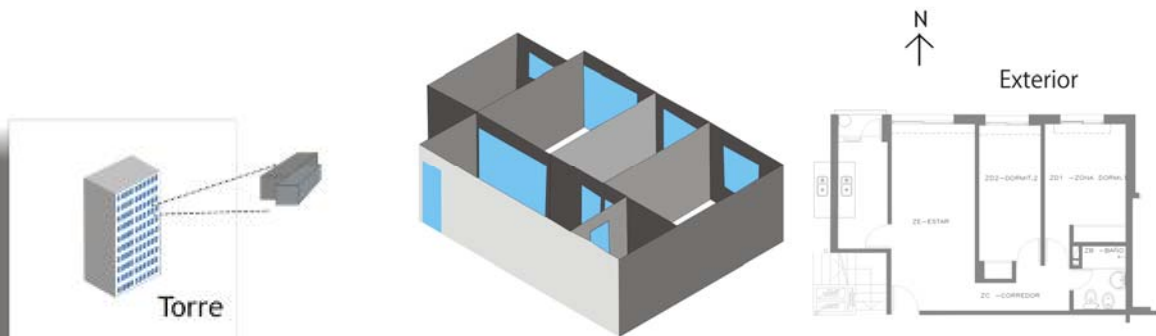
Modelo simplemente orientado y planta tipo de la tipología real
